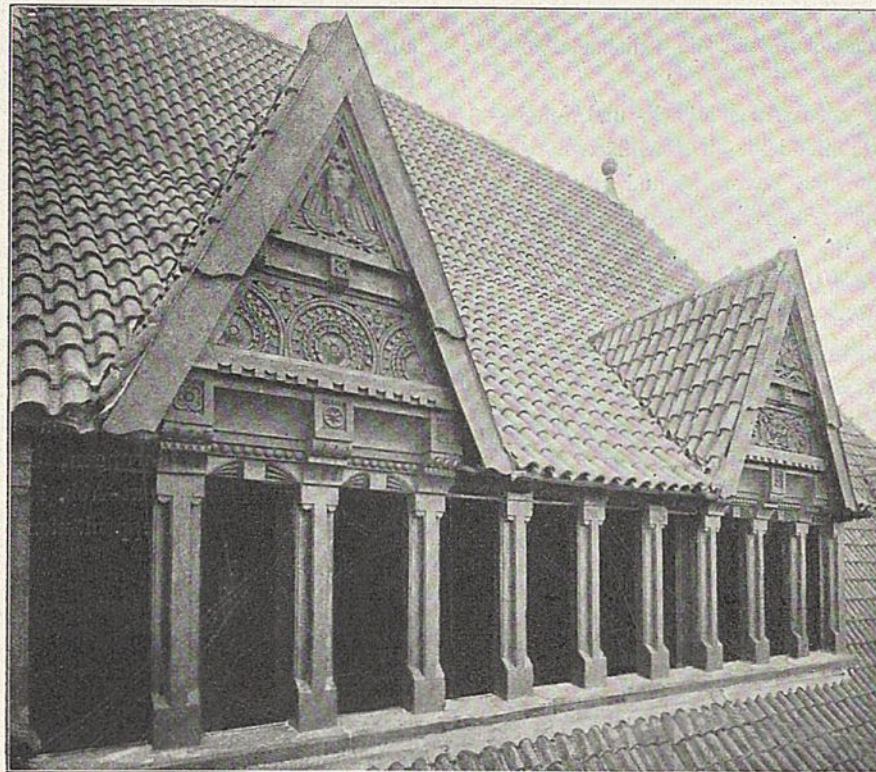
Hölzerner Dachaufbau der Vorderfront.
